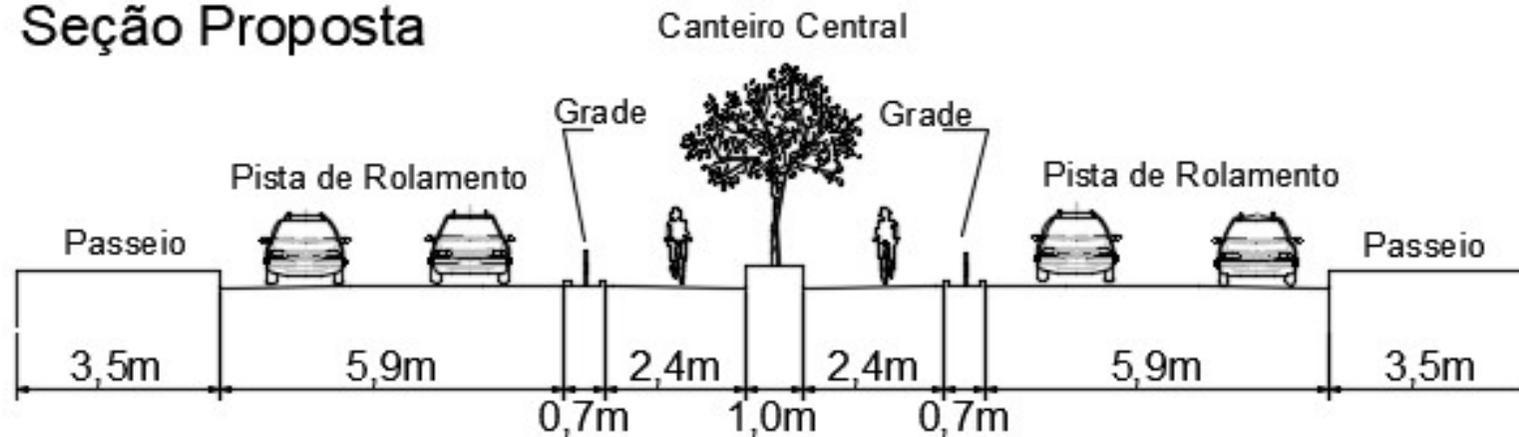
Seção Proposta para ciclovia paralela ao canteiro central da Avenida Boqueirão
